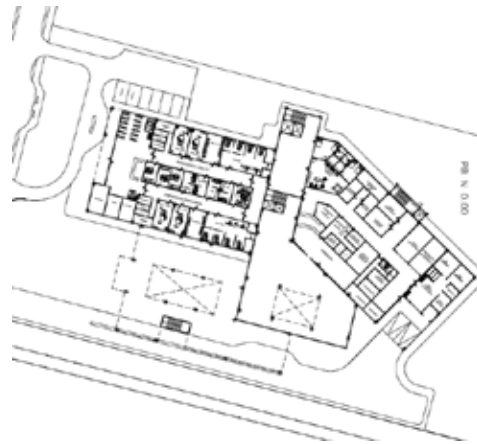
Imagen de Planta baja conjunto del Hospital Tipo I. Rodríguez y otros (2017)
